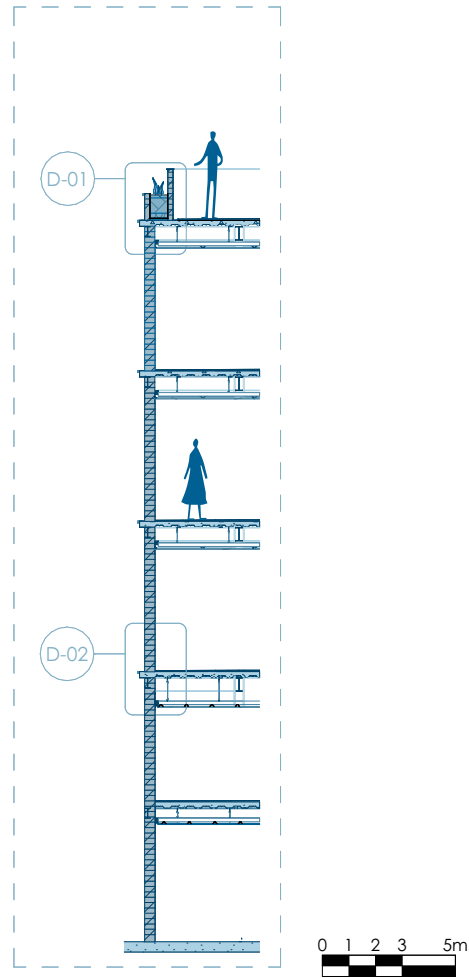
Sección constructiva A. Nota. Elaboración propia.
